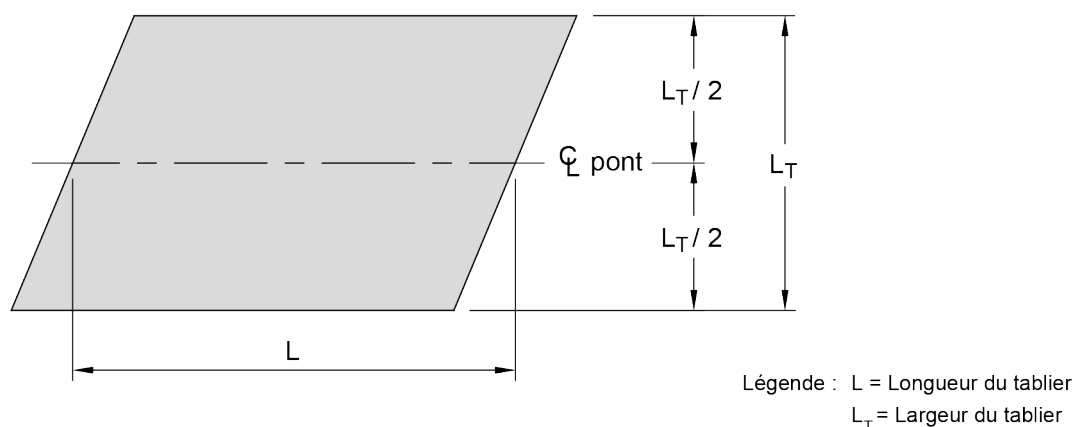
Longueur du tablier d'un pont avec biais
